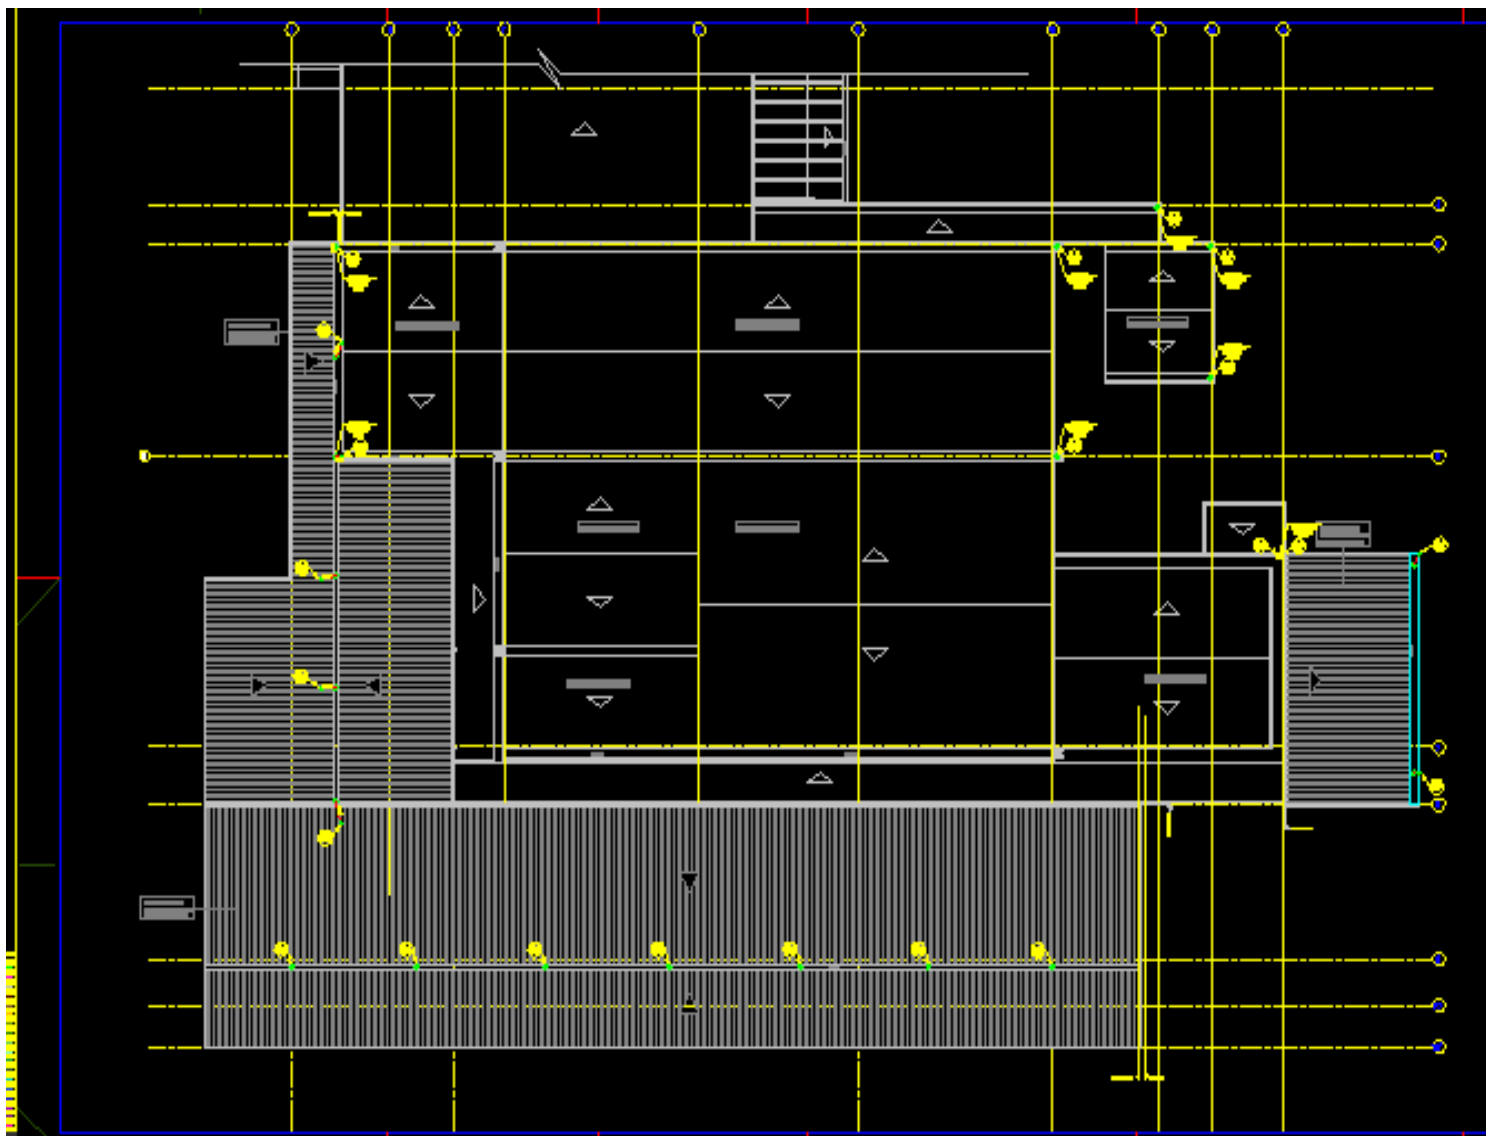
Projeto Arquitetônico - Planta de Cobertura - Restaurante Central da Vale S.A.
